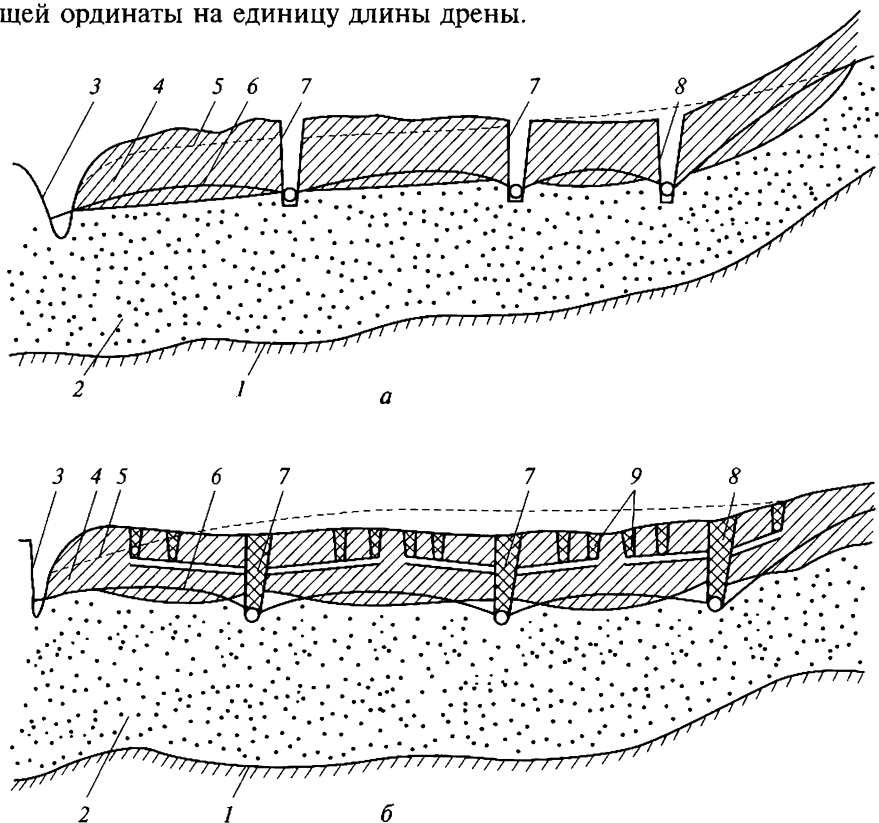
Схема осушительной сети при грунтово-напорном типе питания:
